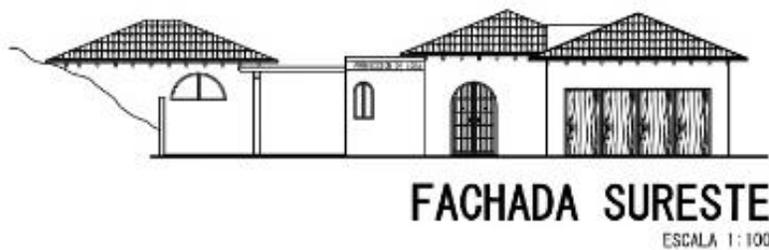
Fachadas y Cortes arquitectónicos de la Casa Habitación del Proyecto Rancho del Mar
